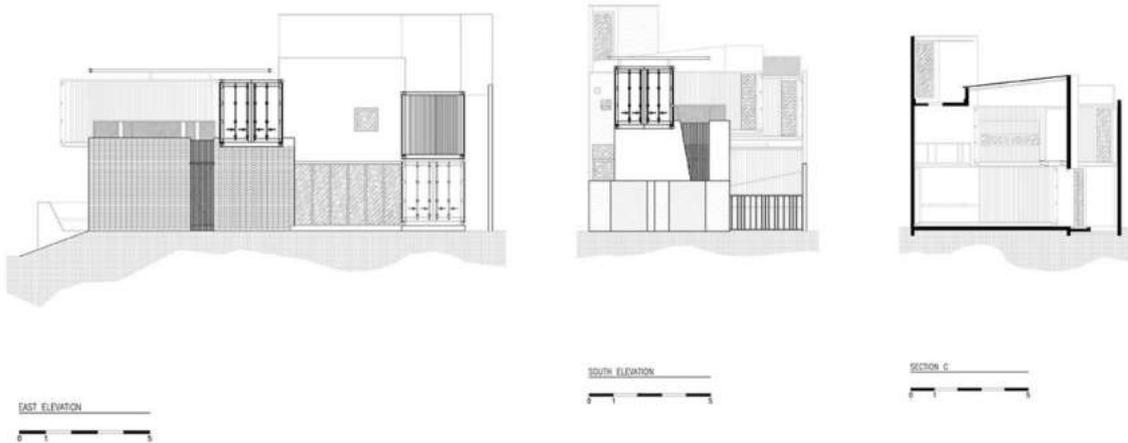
, 16 e 17: Elevações e corte. Fonte: ArchDaily, 2020.
